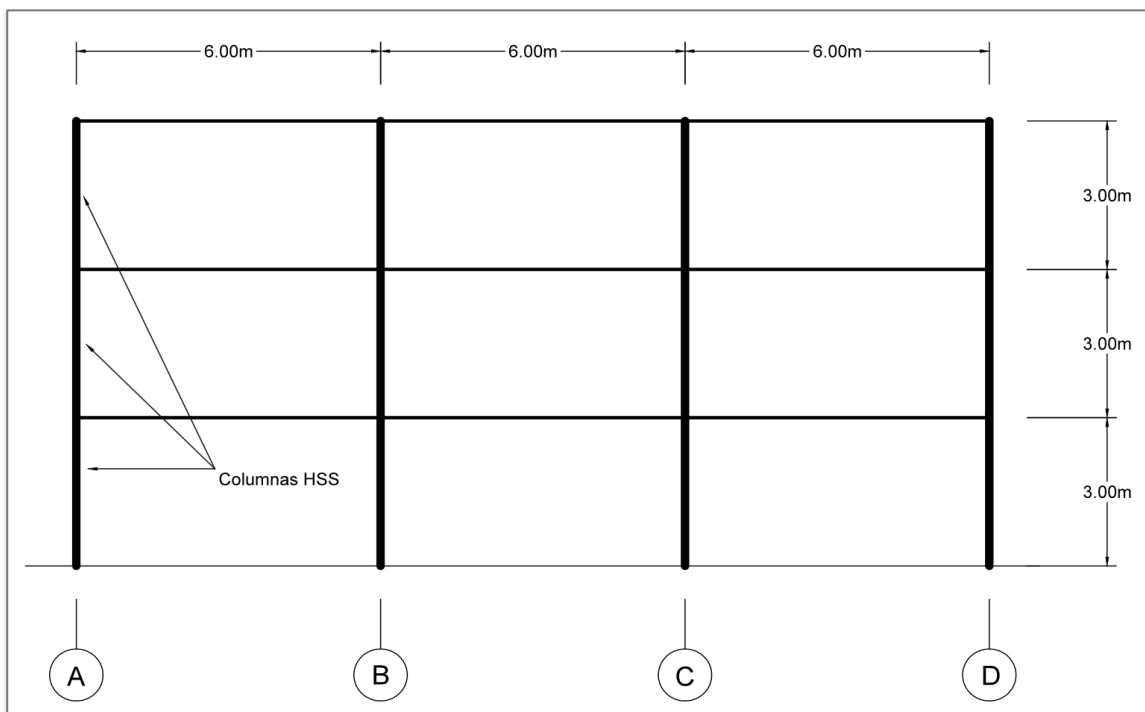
Vista lateral de la estructura. (Elaborado por el autor, 2017)
